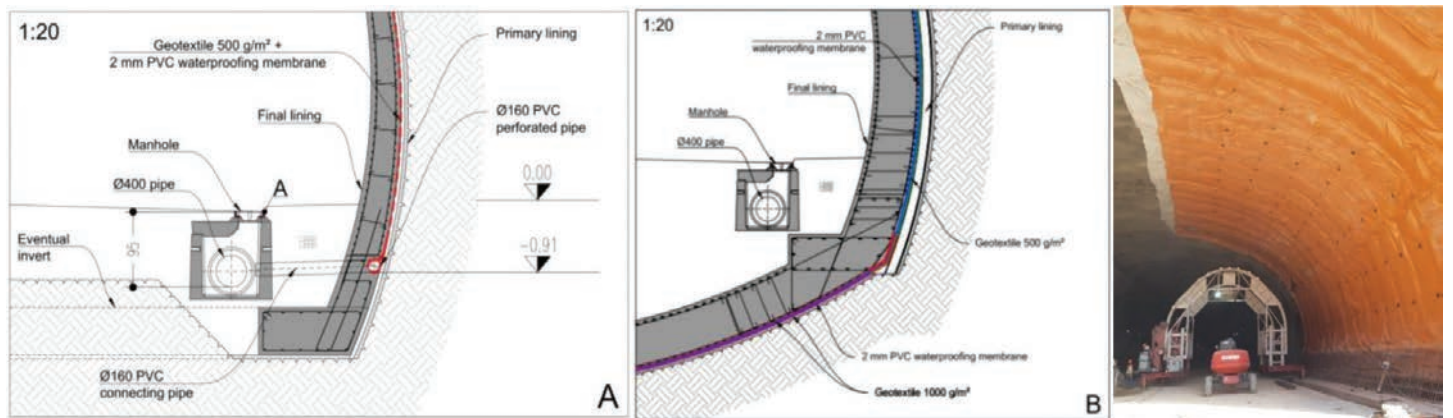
Particolare del sistema di impermeabilizzazione (a) Sezione drenata; (b) Sezione impermeabilizzata (nella Motza).
